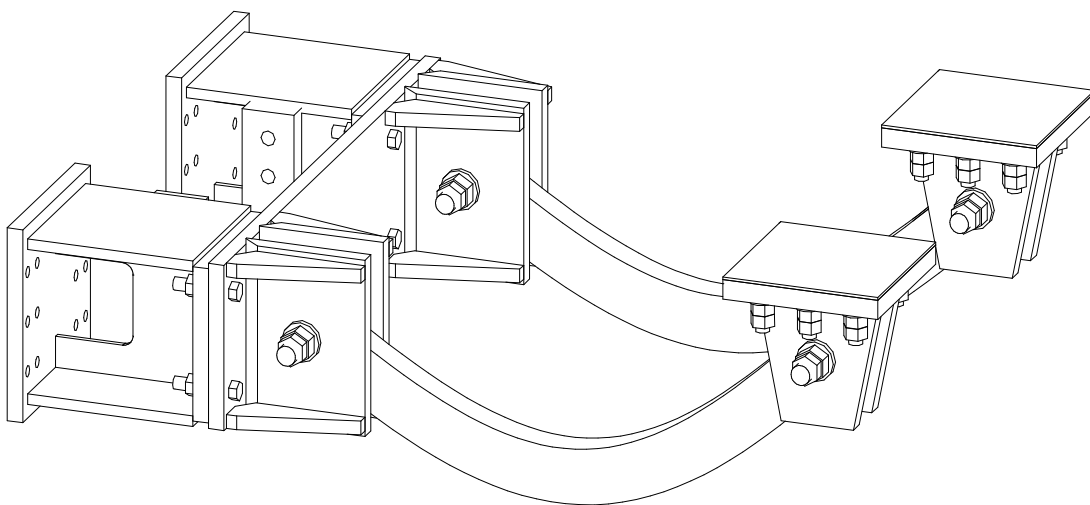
Disposizione degli elementi all'interno della struttura
